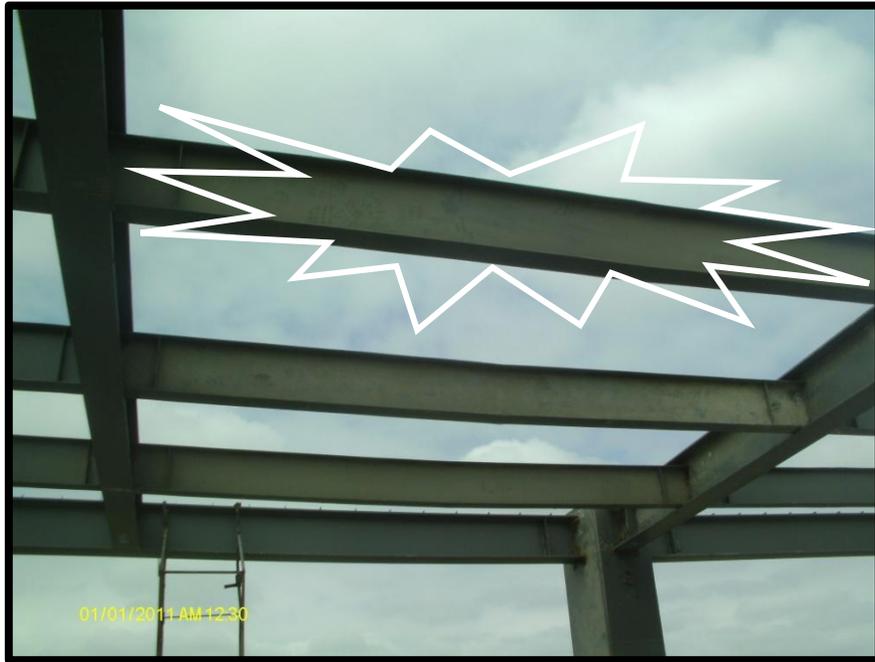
Vigas Montadas Sucias en 8avo Piso
